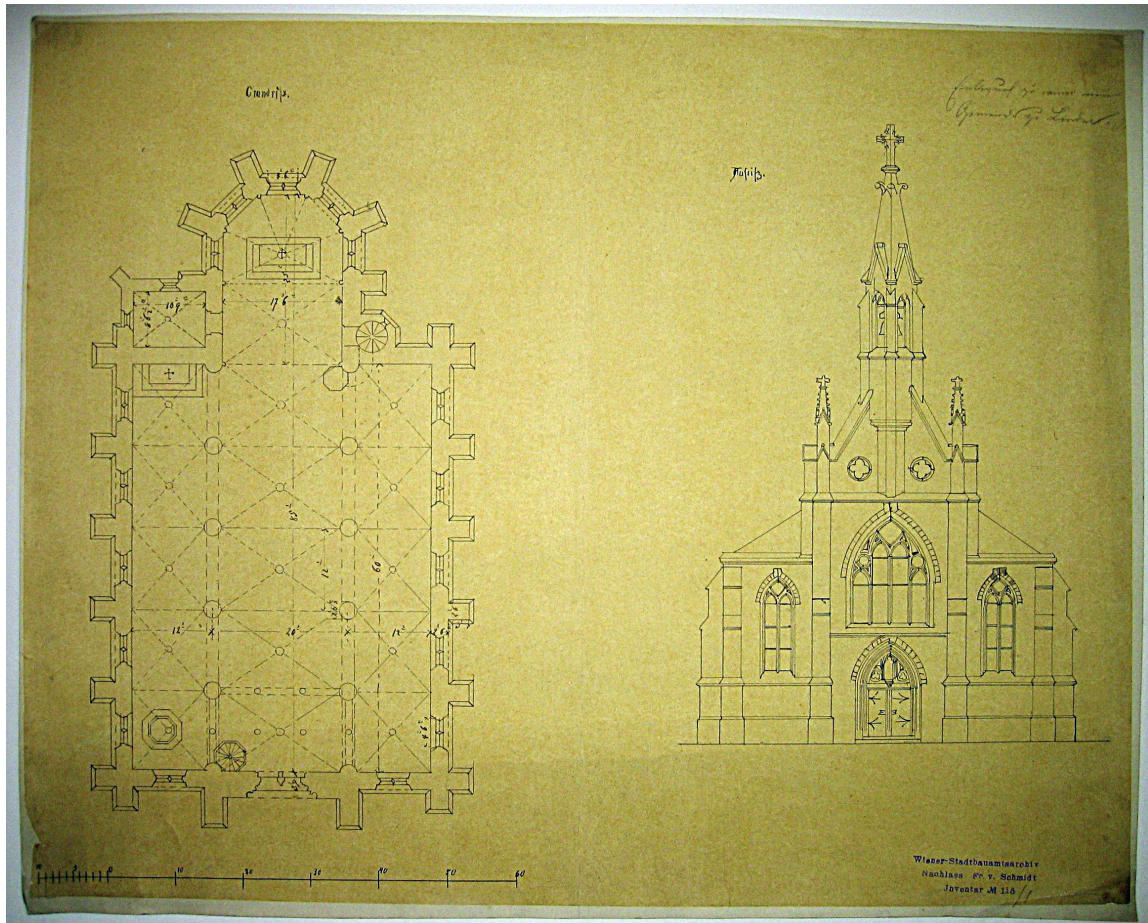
WM, Inv.-Nr. 157.115/1 Grundriss und Frontansicht
